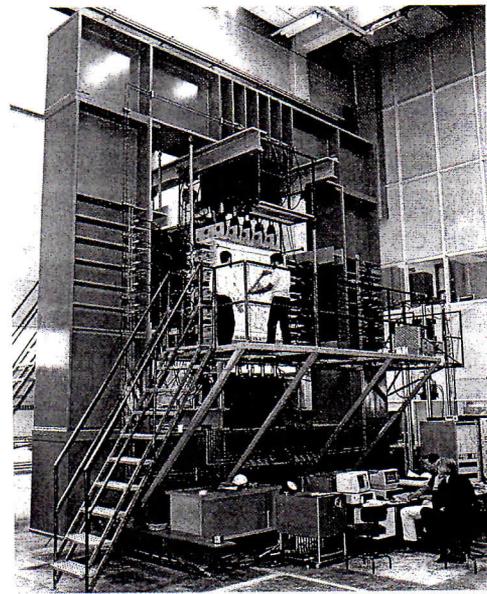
Collins, Stevens らのシェル要素実験装置⁴⁾
